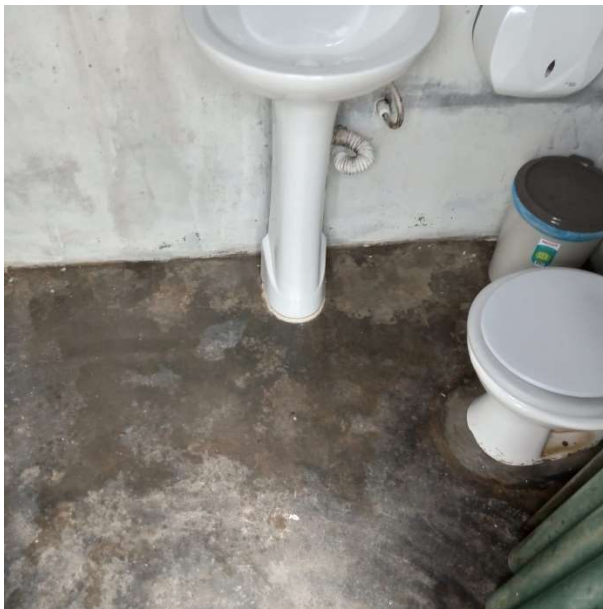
Banheiros exist.: assentamento de revest. cerâmico no piso e nas paredes.
